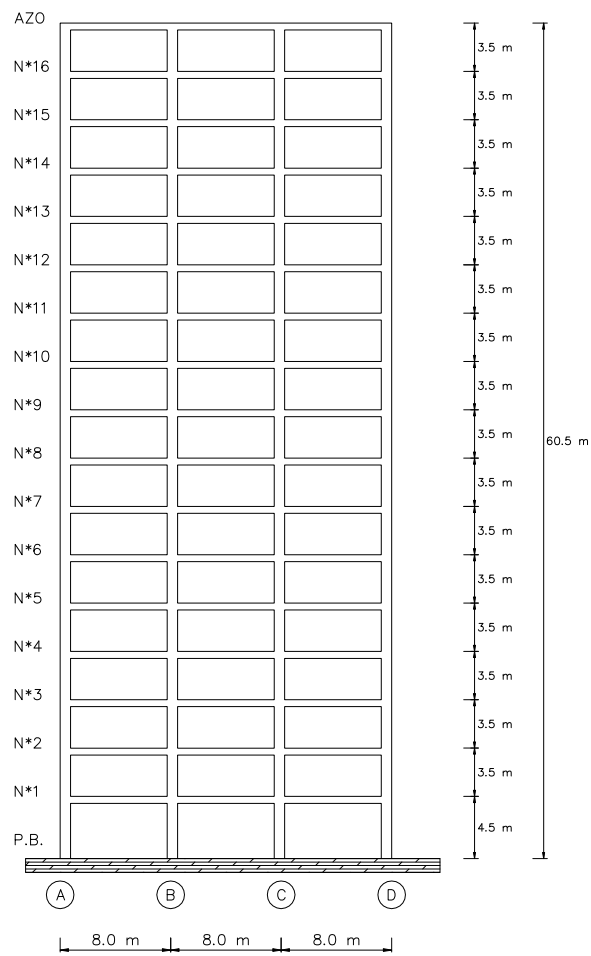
Eje 2 (interior) de las estructuras de 17 niveles
